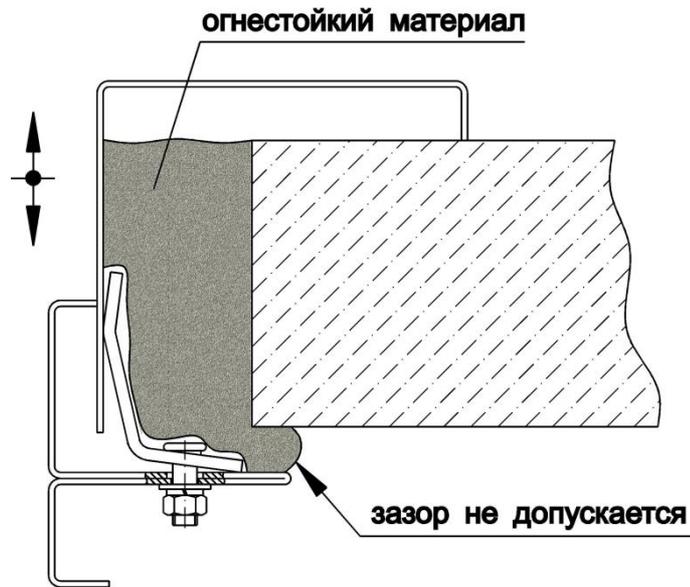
Установка обрамлений противопожарных дверей
